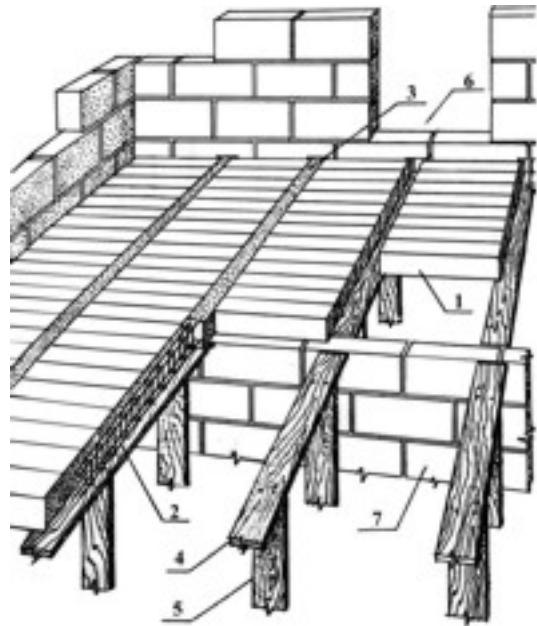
Сборно-монолитное перекрытие из мелких газобетонных блоков:
